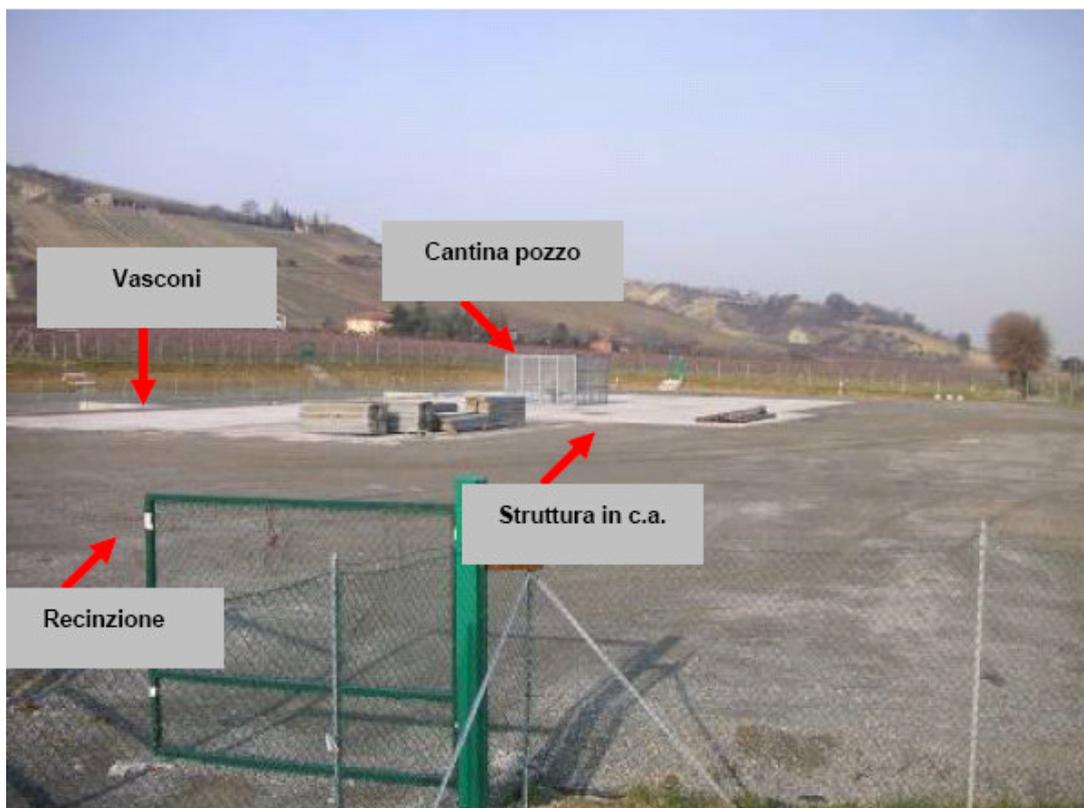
Vista dell'attuale configurazione del piazzale del pozzo Mezzocolle 1 Dir
